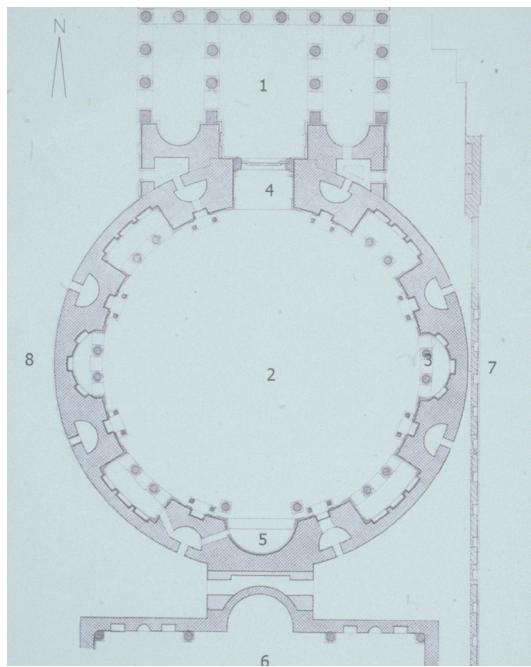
Pantheon. Grundriss mit Resten der Nachbarbebauung.
